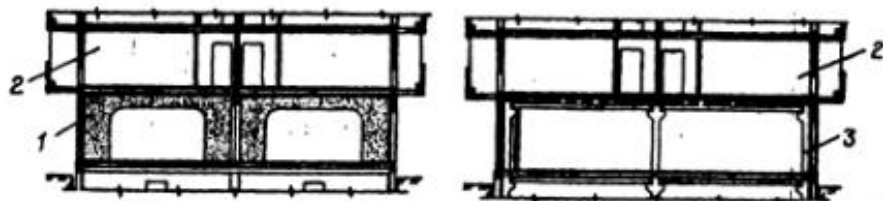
Примеры комбинированных строительных систем: 1 - монолитные стены, 2 - панельные стены, 3 - сборный железобетонный каркас
